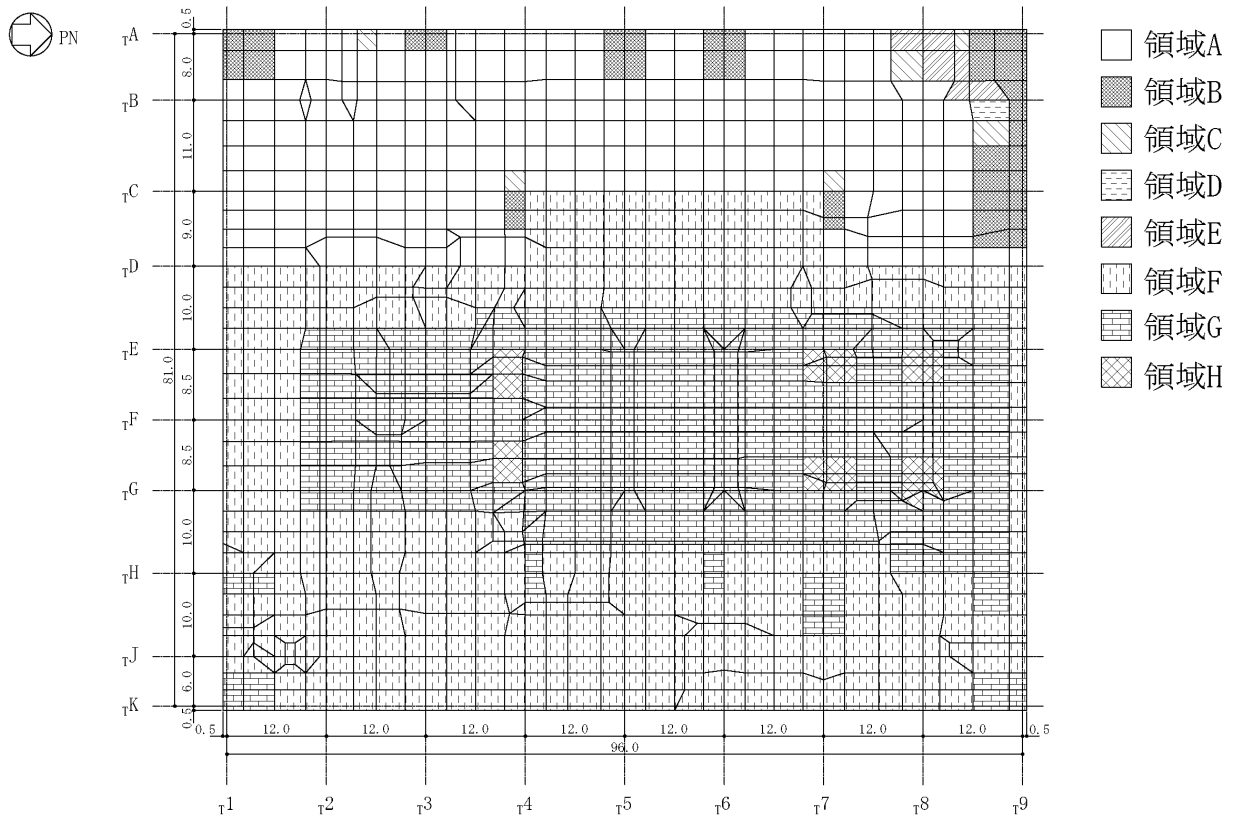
基礎スラブの配筋領域図 (NS 方向, 下ば筋) (単位 : m)
